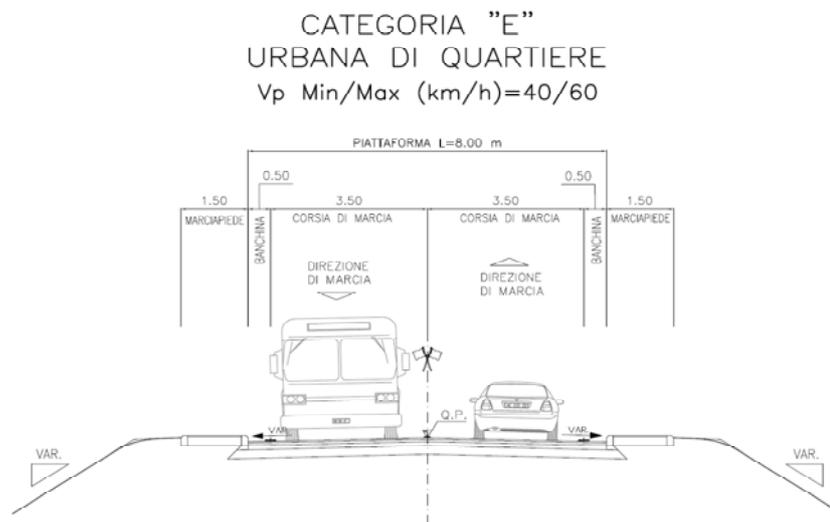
Sezione tipo Collegamento Via Agucchi – Asse Attrezzato
